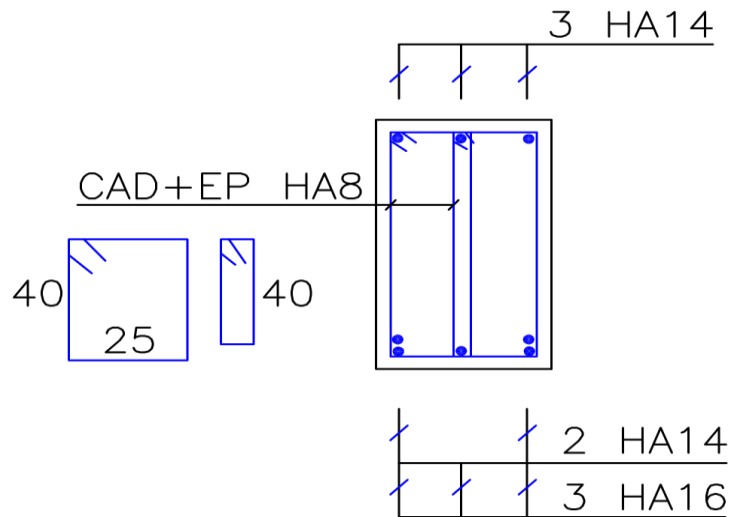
Ferrailage des poutres principales au niveaux RDC à 6^{ème} étage
